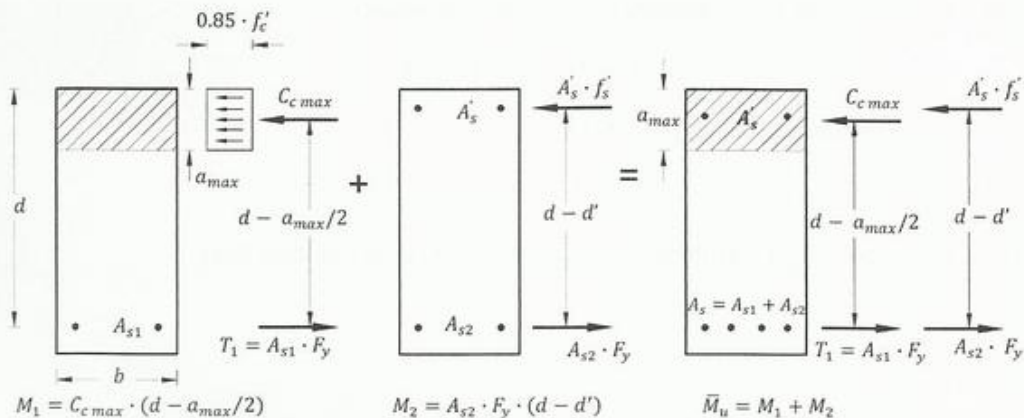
Armadura doble. Fuerzas en el concreto y acero
